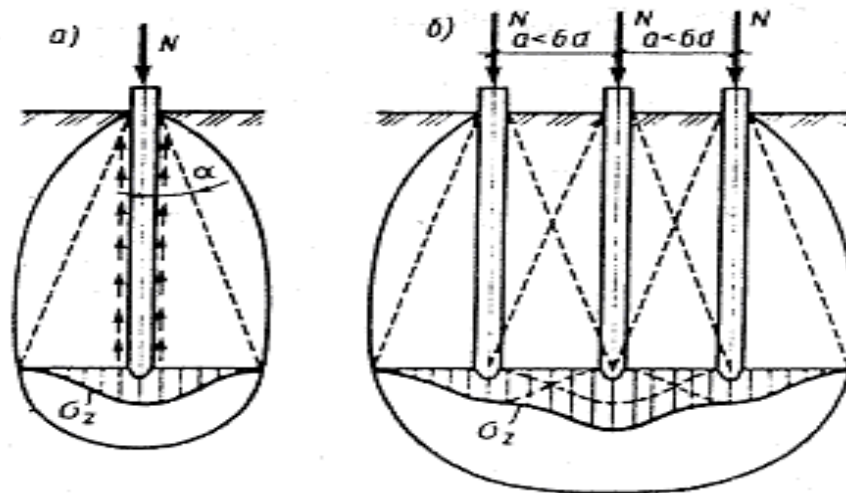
Схемы передачи нагрузки на грунт основания:
